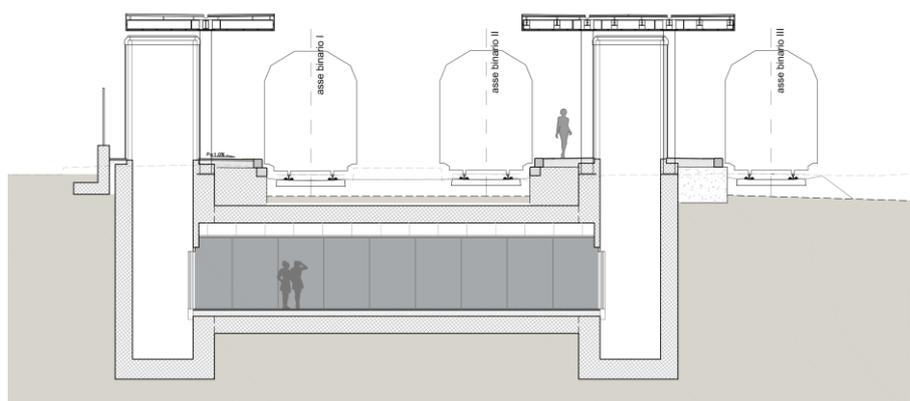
Sezione in asse al sottopasso, trasversale alle pensiline
